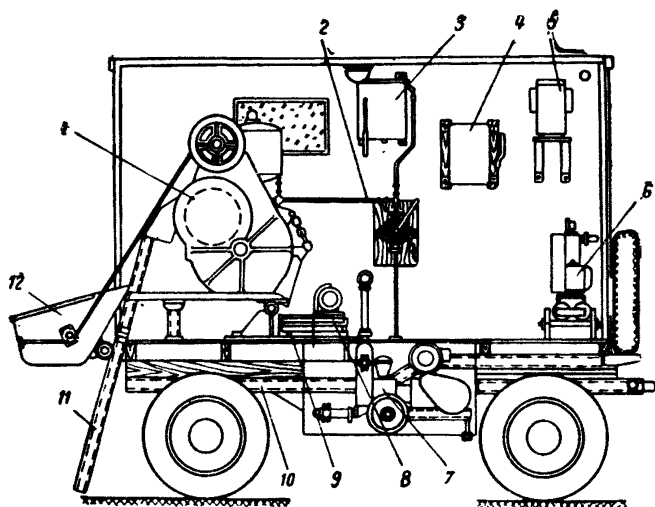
Установка ЦНИЛ-3 для нанесения холодной асфальтовой гидроизоляции
